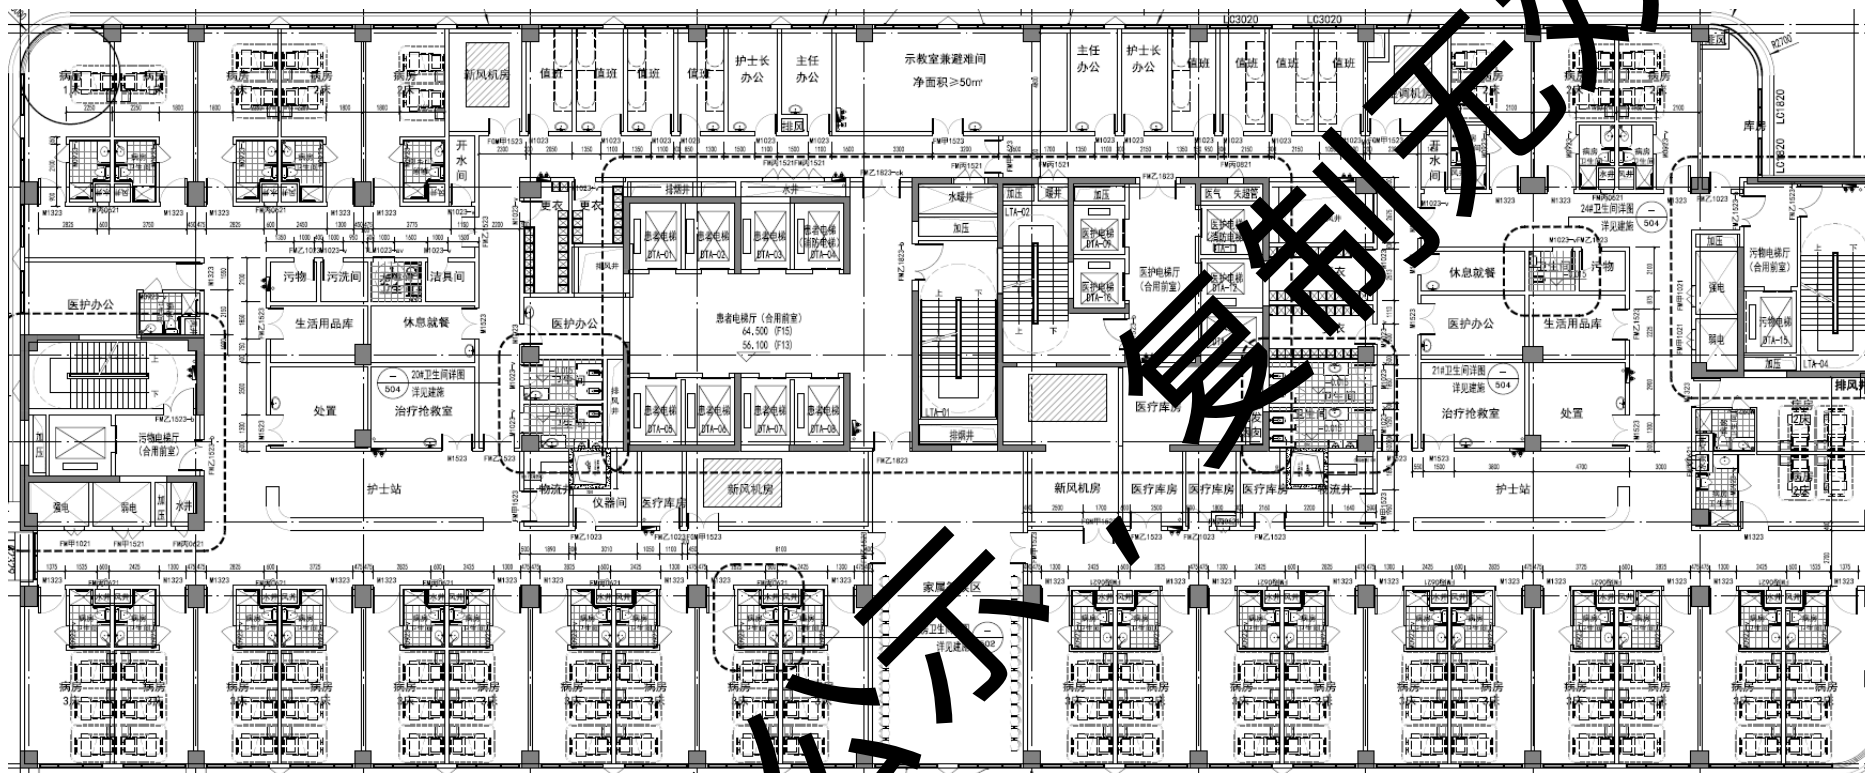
本项目新建住院综合楼 13F、15F 平面布置图
